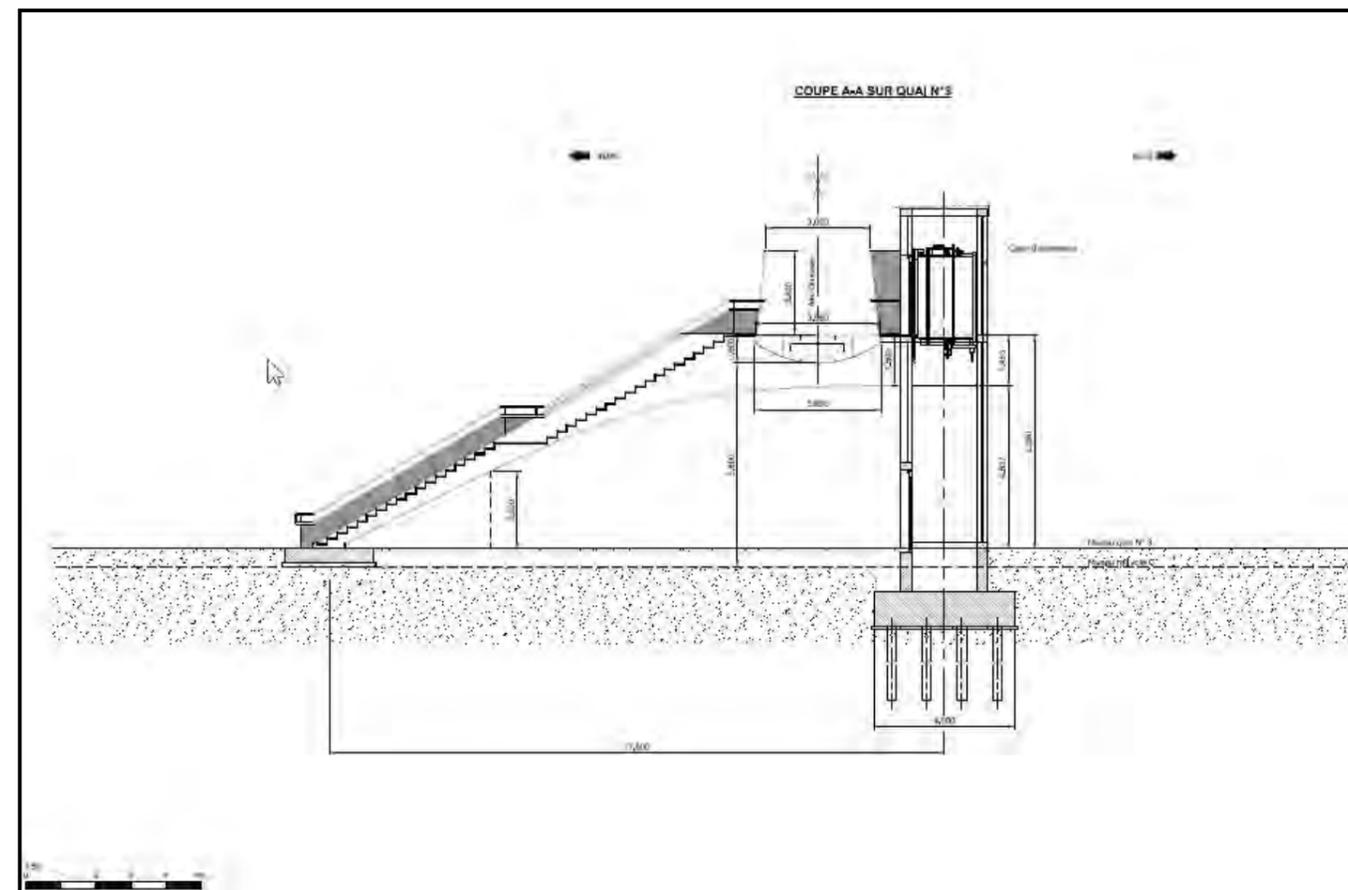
Coupe longitudinale de la passerelle au droit d'un quai avec de gauche à droite : l'escalier, la passerelle proprement dite l'ascenseur et sa tour qui accompagne la pile de soutien ancrée en sous-sol sur ses fondations
